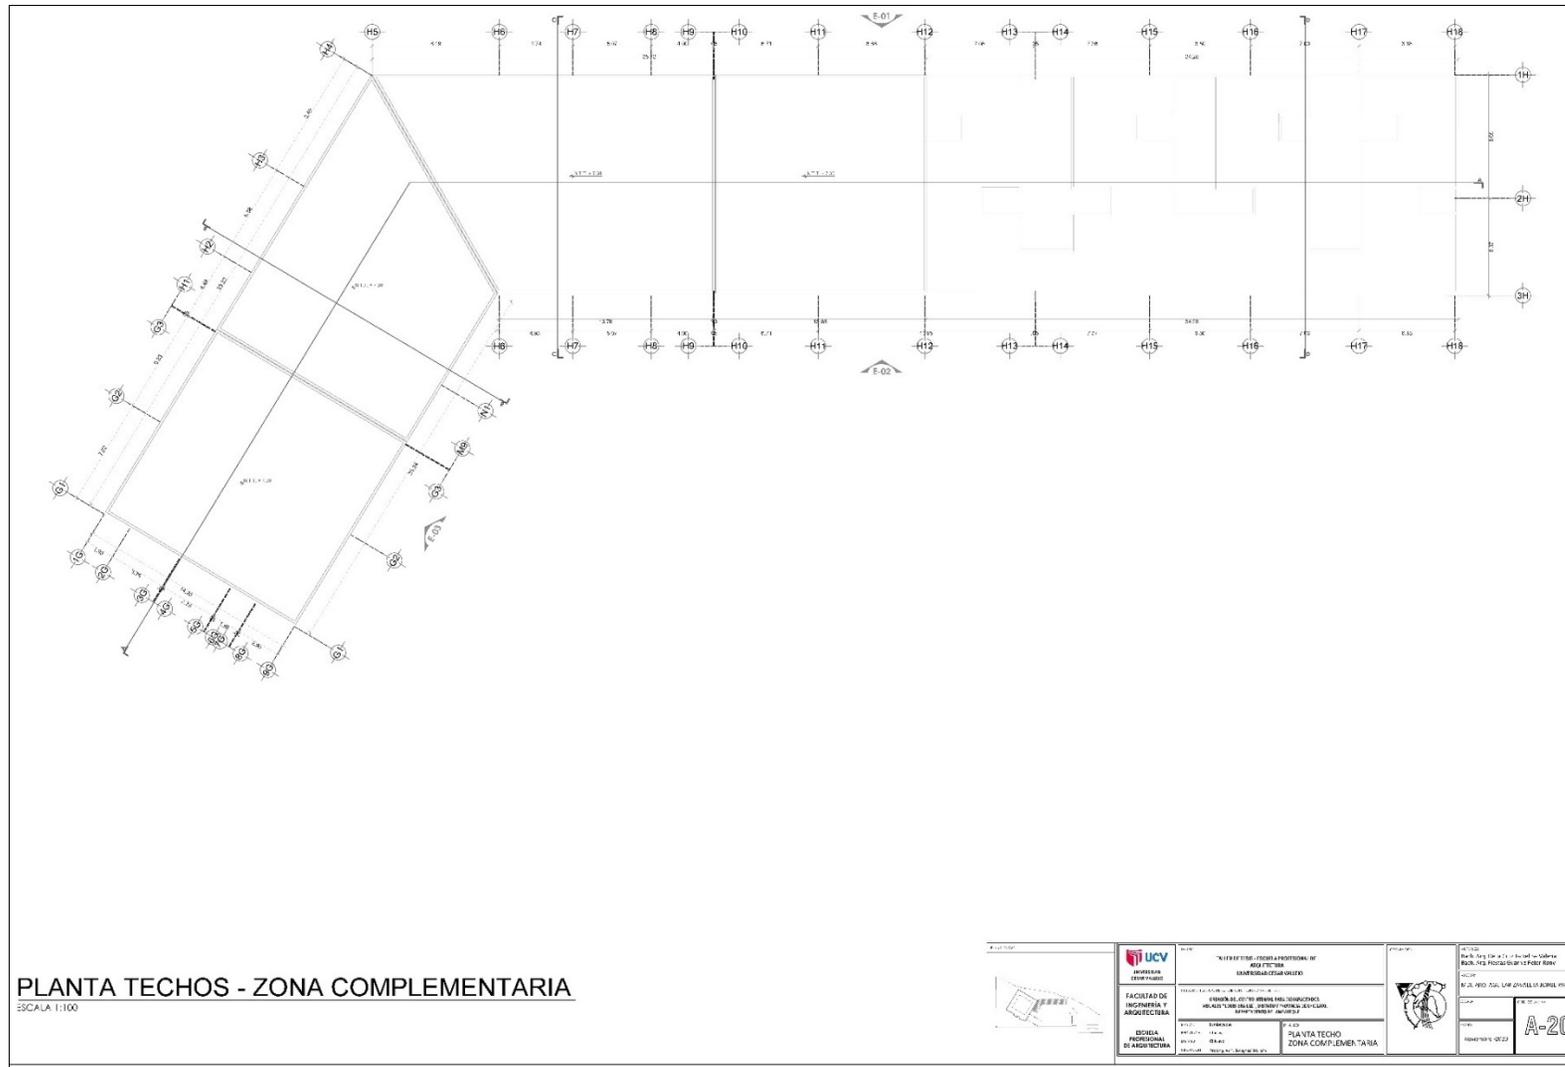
Planta techo-zona complementaria. Fuente: elaboración propia.
